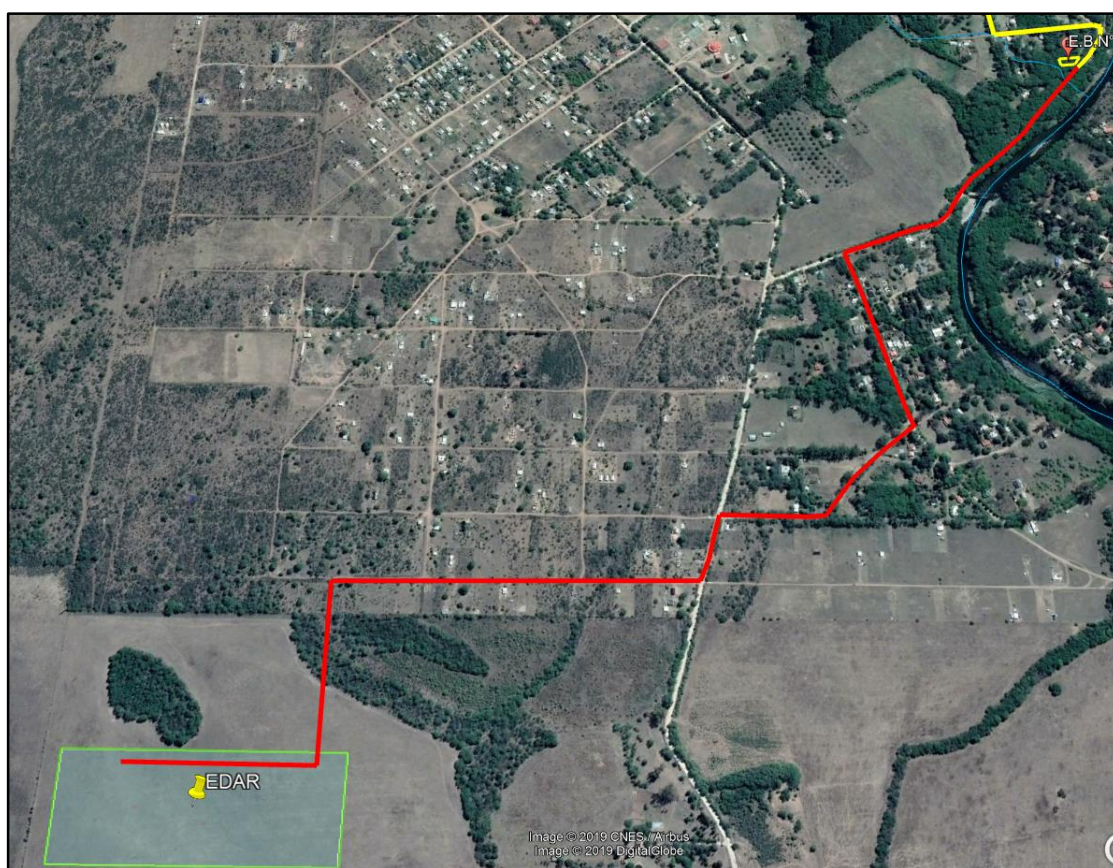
PLANIMETRÍA DE CAÑERÍA DE IMPULSIÓN.
